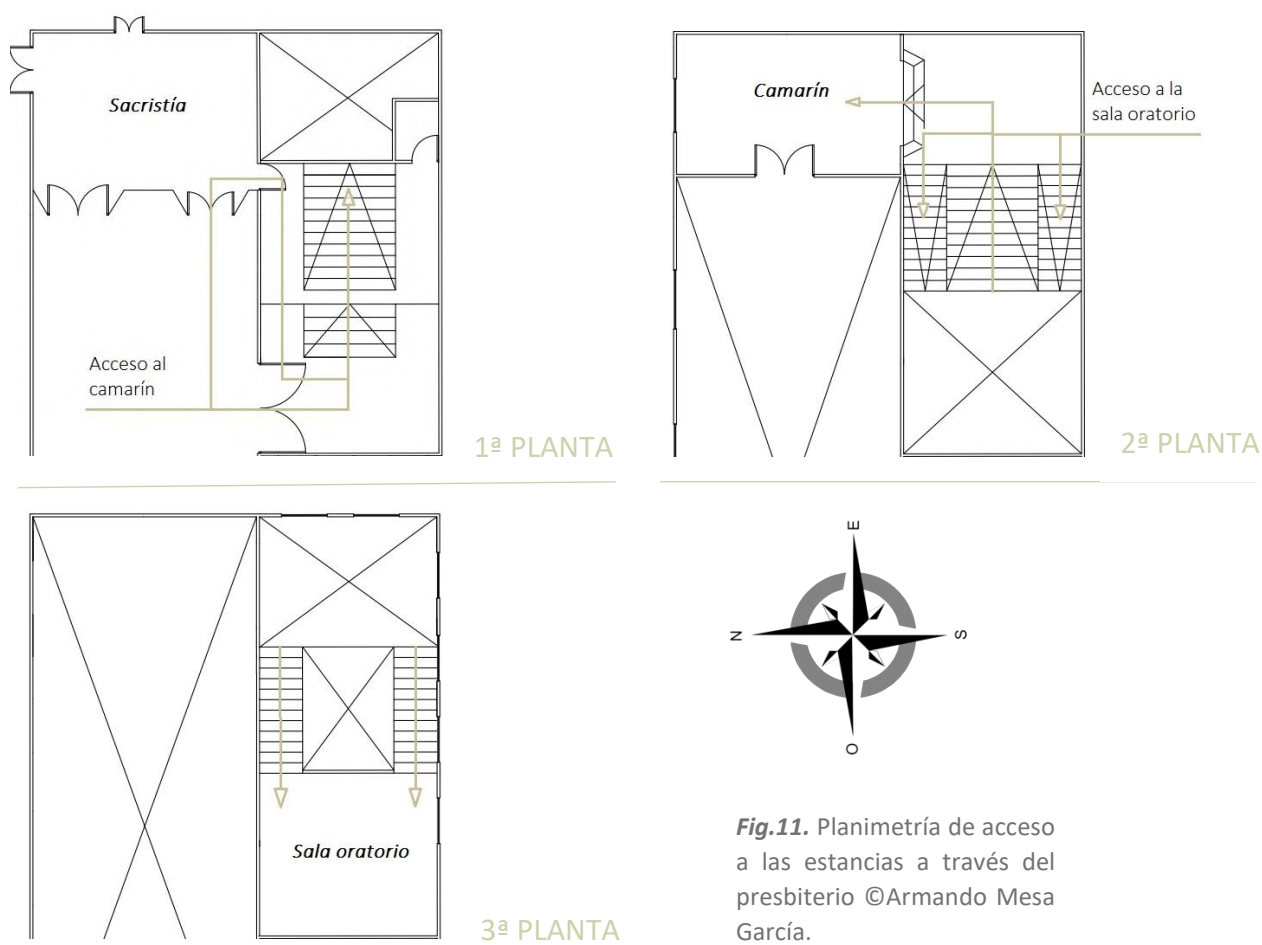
Planimetría de acceso a las estancias a través del presbiterio ©Armando Mesa García.
